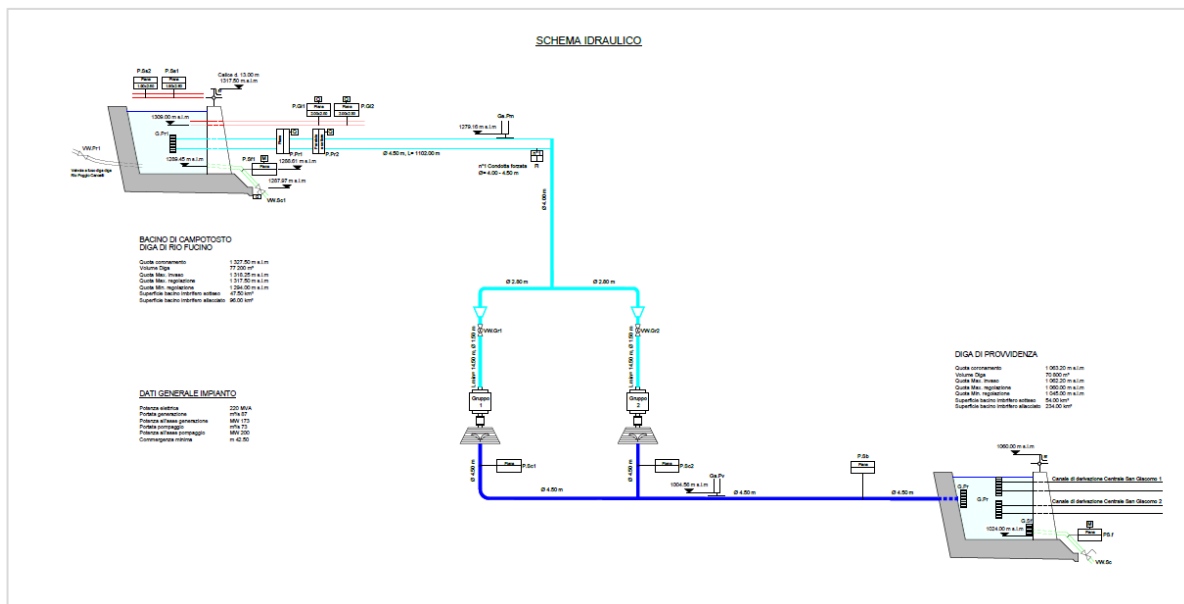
Impianto di Provvidenza – Schema idraulico delle opere in progetto
